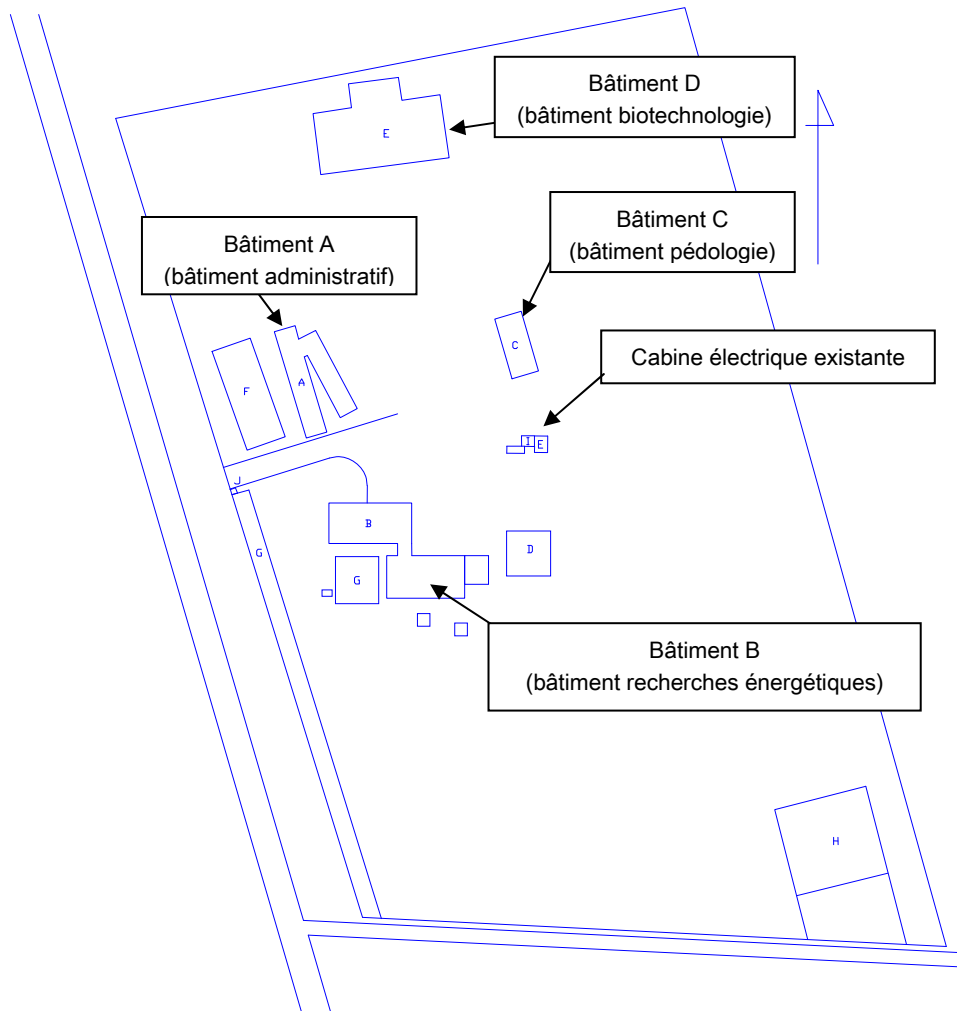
Plan de disposition des installations à l'intérieur du CERD
